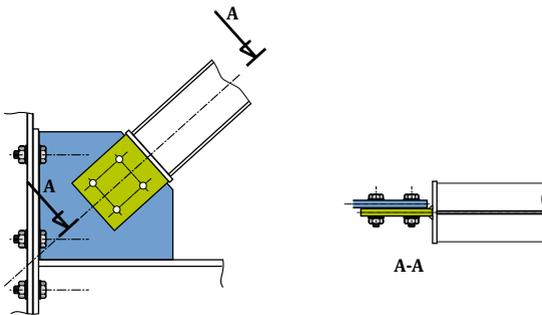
Assemblage par gousset soudé sur platine d'about pour une diagonale à section laminée en H
